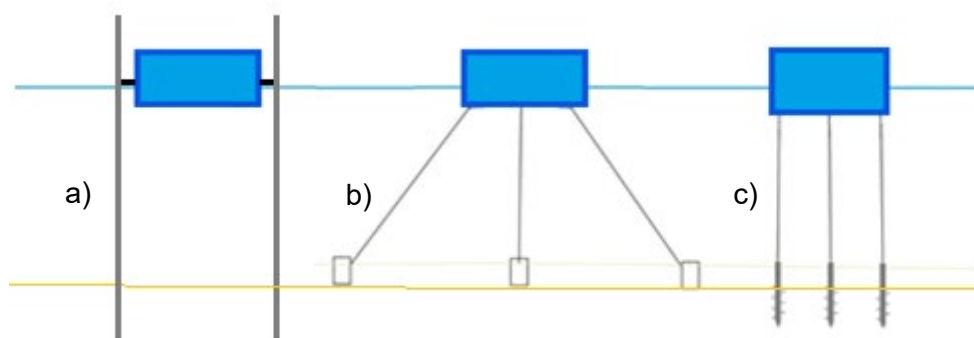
Sistemi di ormeggio e ancoraggio al fondale
